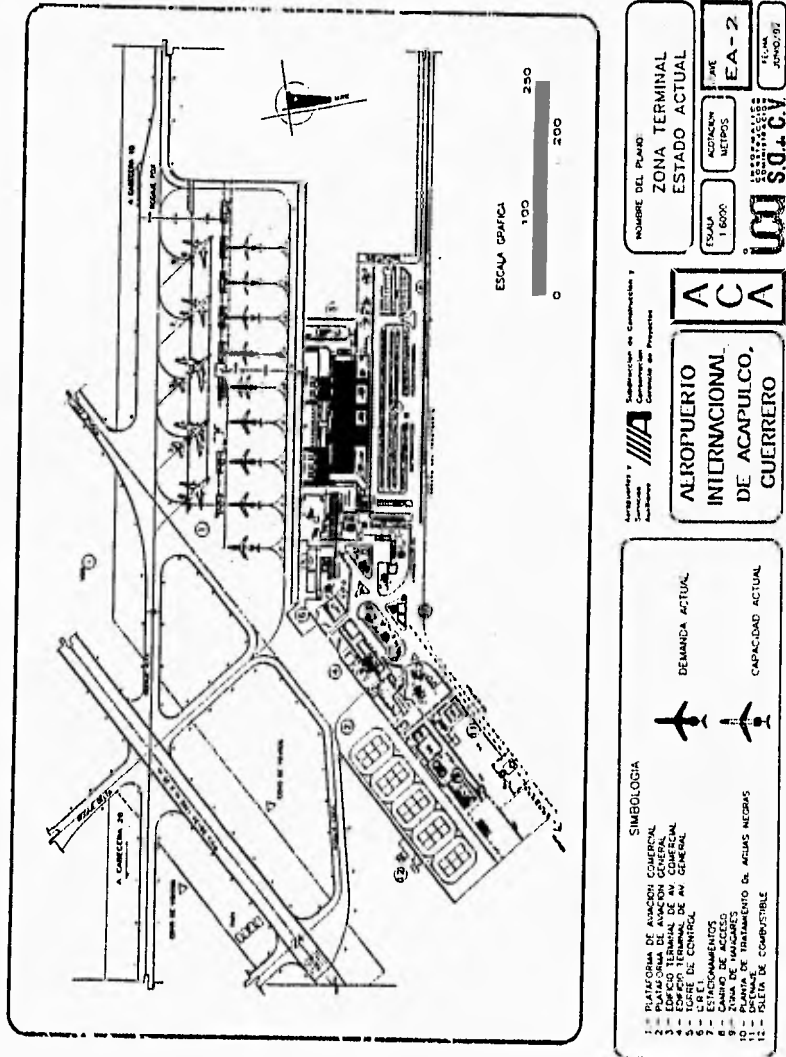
Planta de Conjunto del Aeropuerto Internacional de Acapulco.
